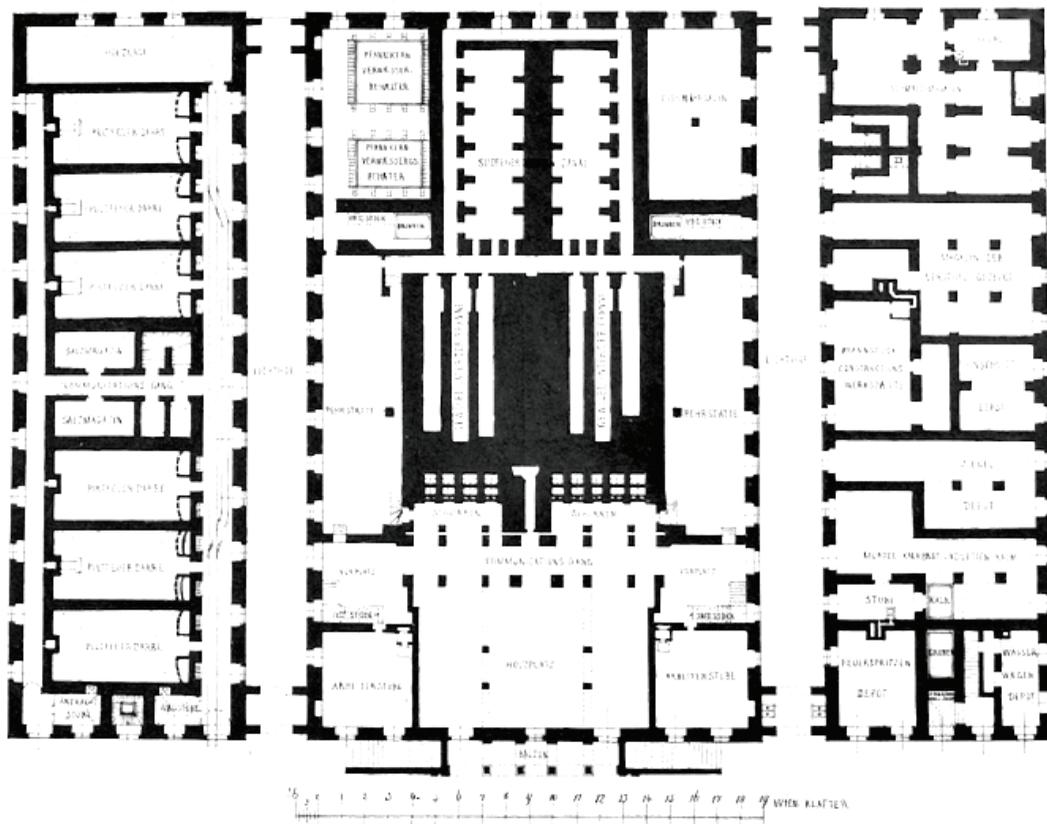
Kolowrat Sudhaus, Grundriss EG, 19. Jhd.
